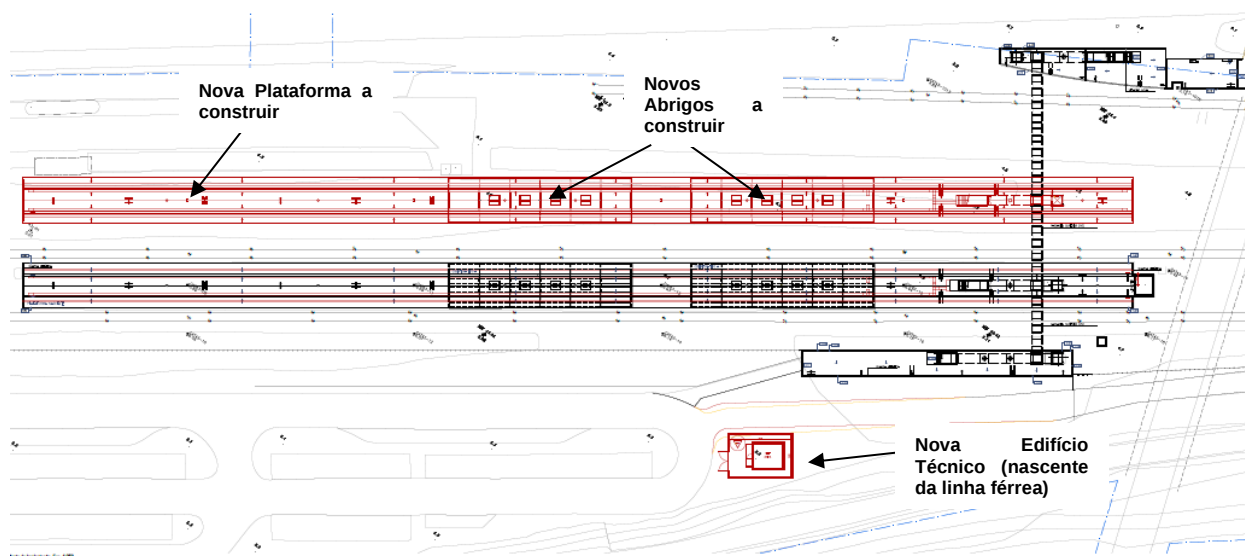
Layout do apeadeiro de Espadanal da Azambuja e proposta de intervenções
